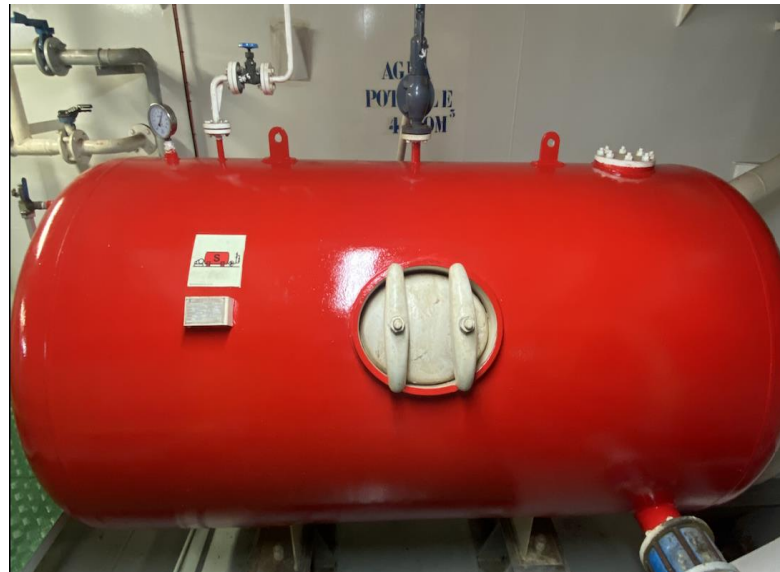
Tanque de sprinkler. Fuente: Elaboración propia
